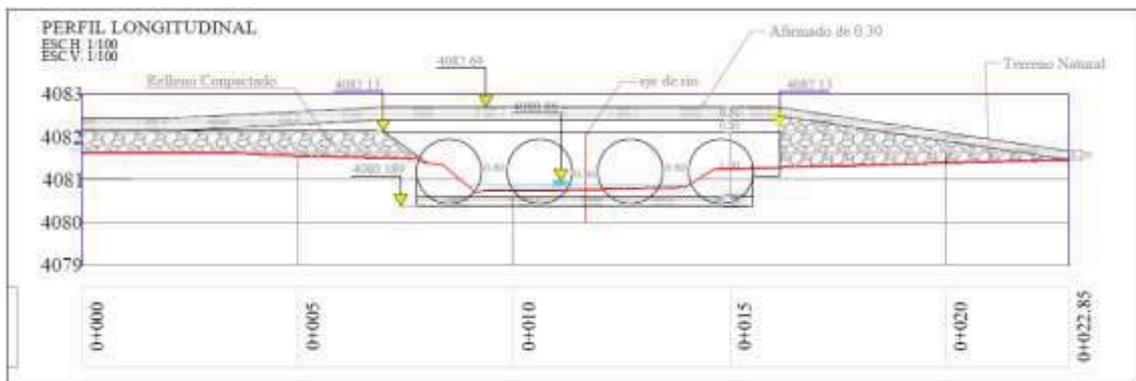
Detalle de la alcantarilla del puente N° 02
